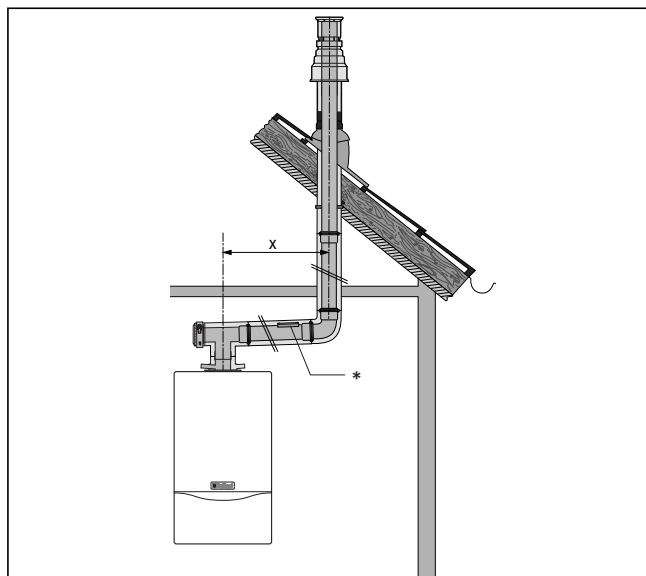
Esempio di montaggio passante verticale a tetto
